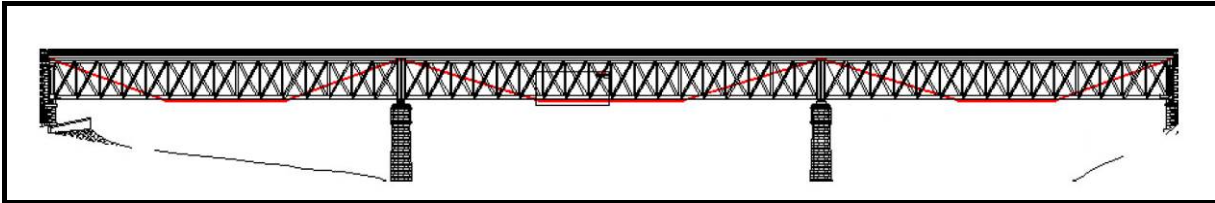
Traçado típico, a vermelho, do pré-esforço exterior [10]
